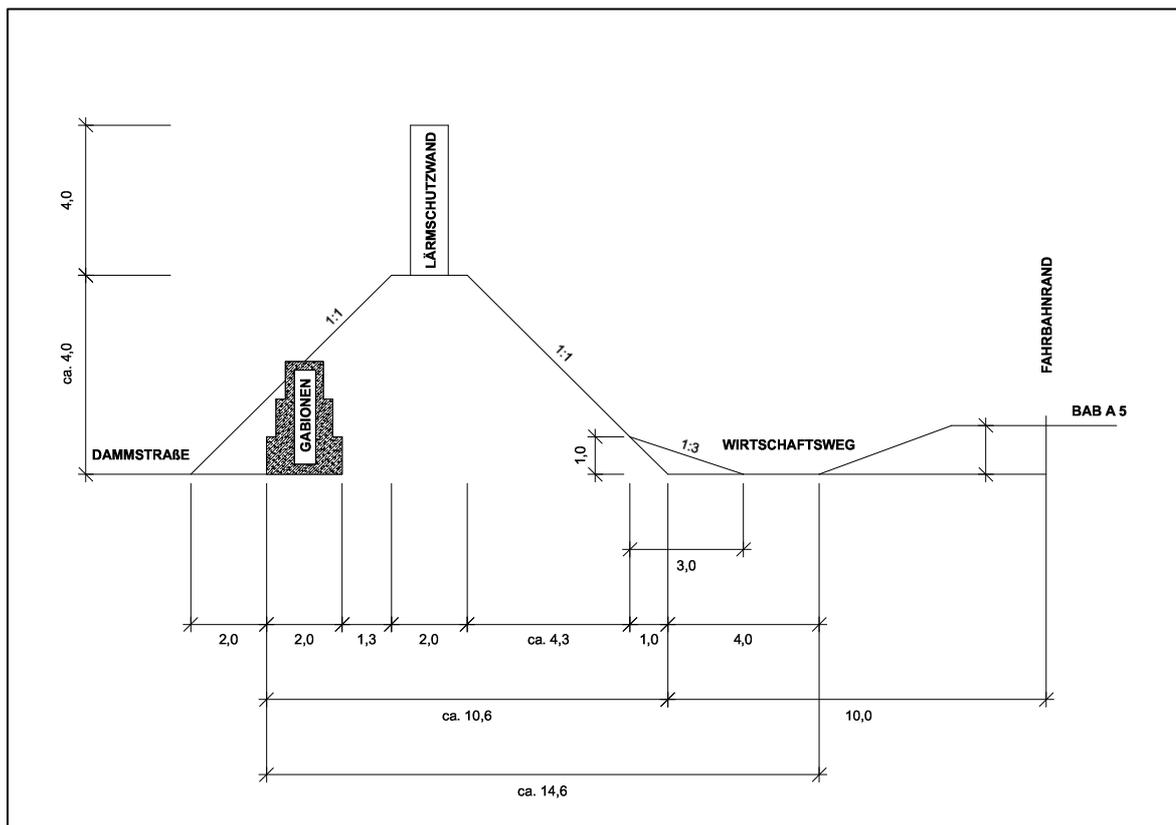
Lärmschutzwallausbildung entlang der Bundesautobahn A 5
